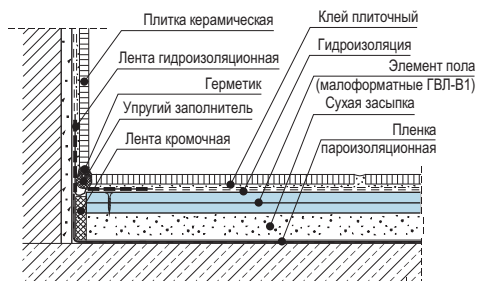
Примыкание к стене во влажном помещении (ванная комната)
